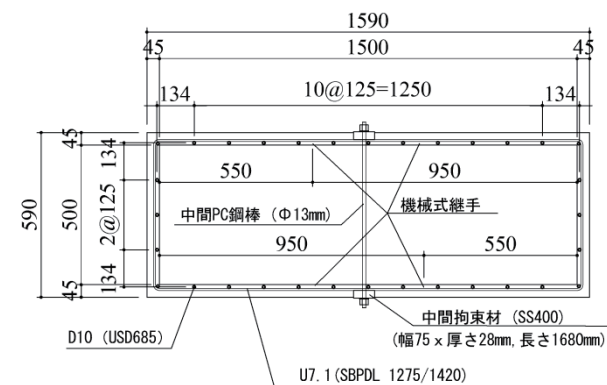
補強部の試験体配筋状況 (ケース B1)
